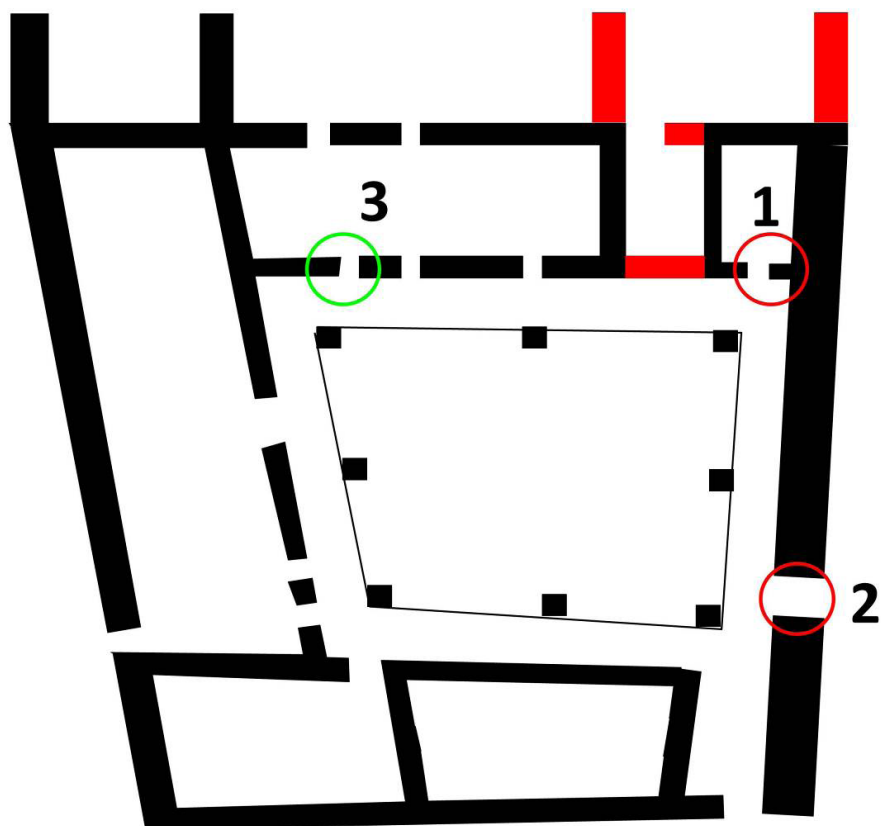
Plano de la vivienda del Patio Castellano. (PabloGumiel©).
